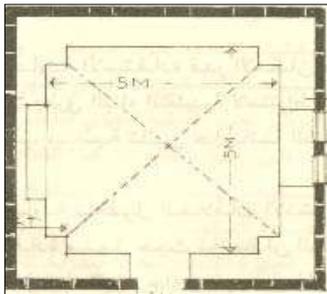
مسقط الدور الأرضي بيت العمصي، حي الدرج
